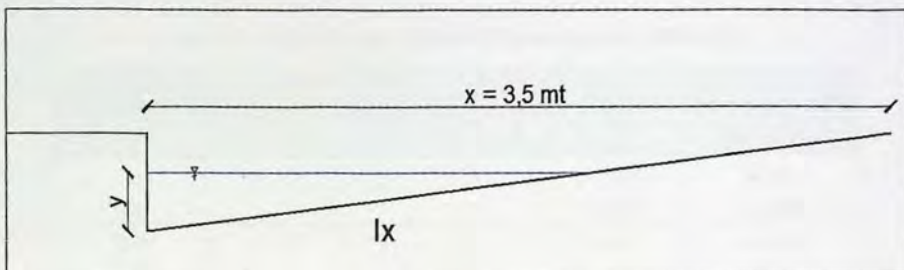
Corte esquema calle de ancho 3,5 metros
